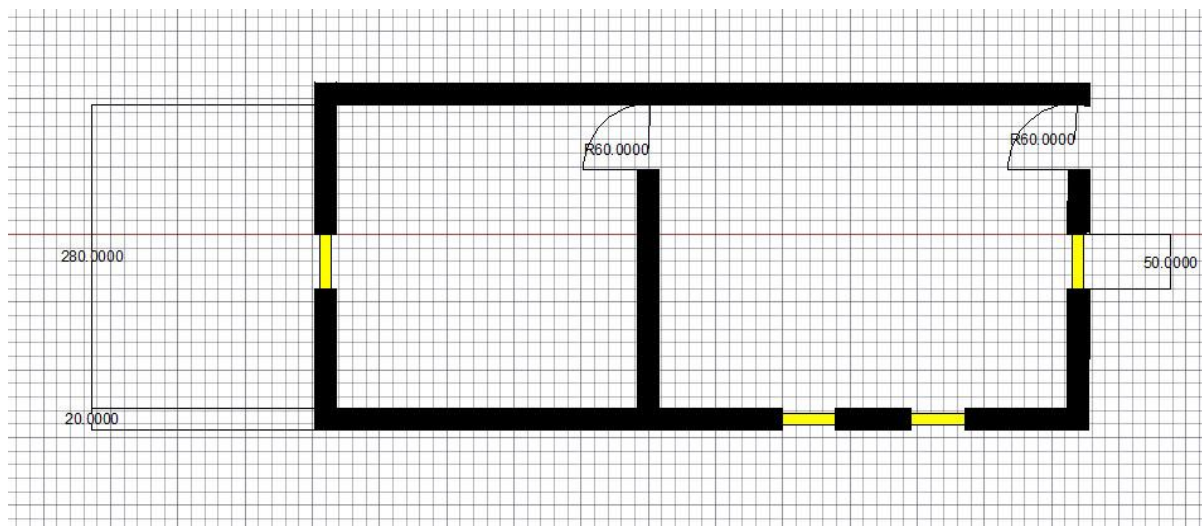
Exemplu de plan al unei locuințe realizat cu AutoCAD
